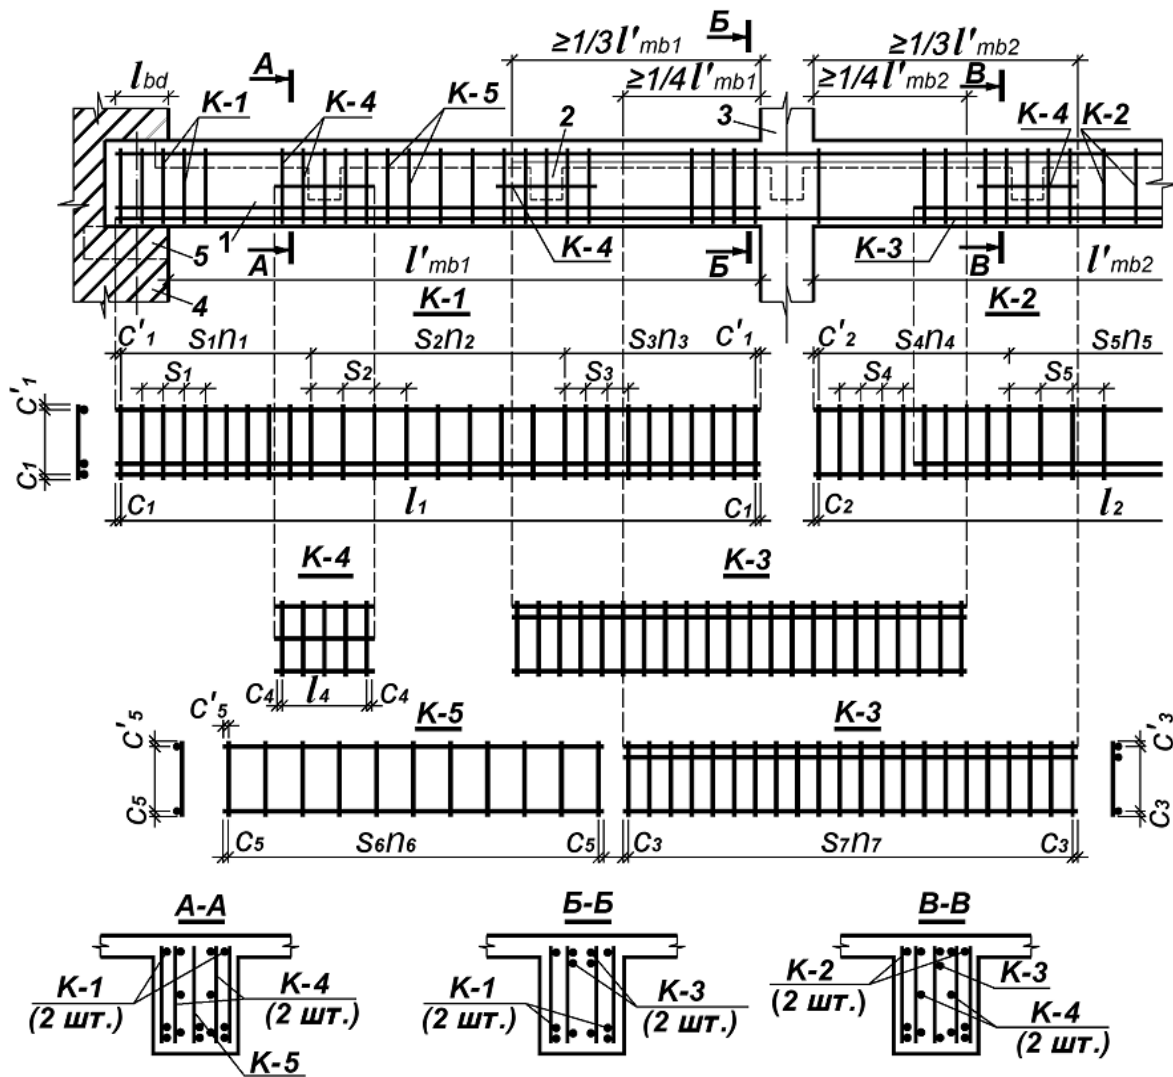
Армування головних балок зварними каркасами:
